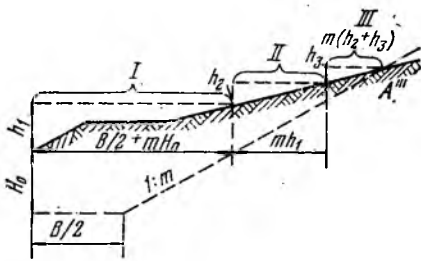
Схема разбивки выемки на косогоре с различным поперечным уклоном
